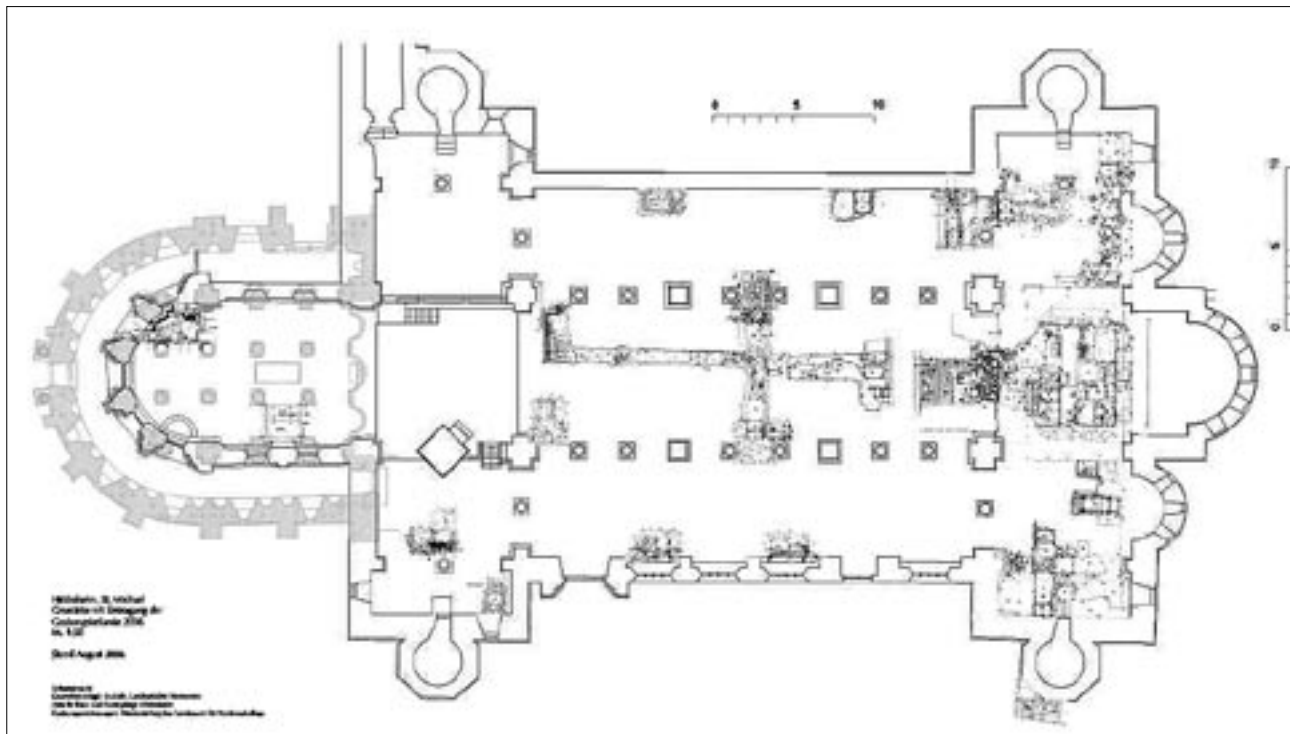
Grundriss der Kirche St. Michaelis mit eingetragenen Grabungsflächen.
